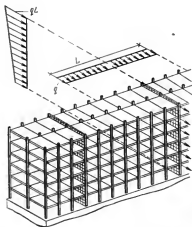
Передача ветровой нагрузки на вертикальные диафрагмы в здании со связевым каркасом
